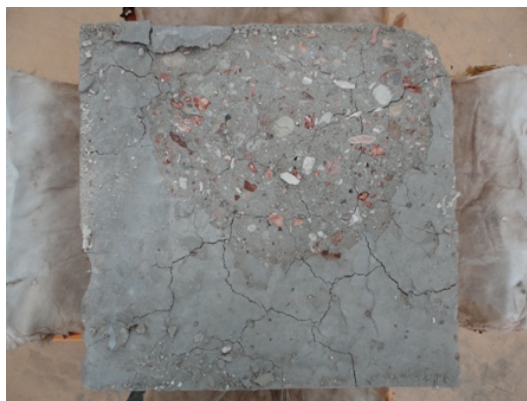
Superfície que ficou diretamente exposta ao aquecimento do CAD-600
